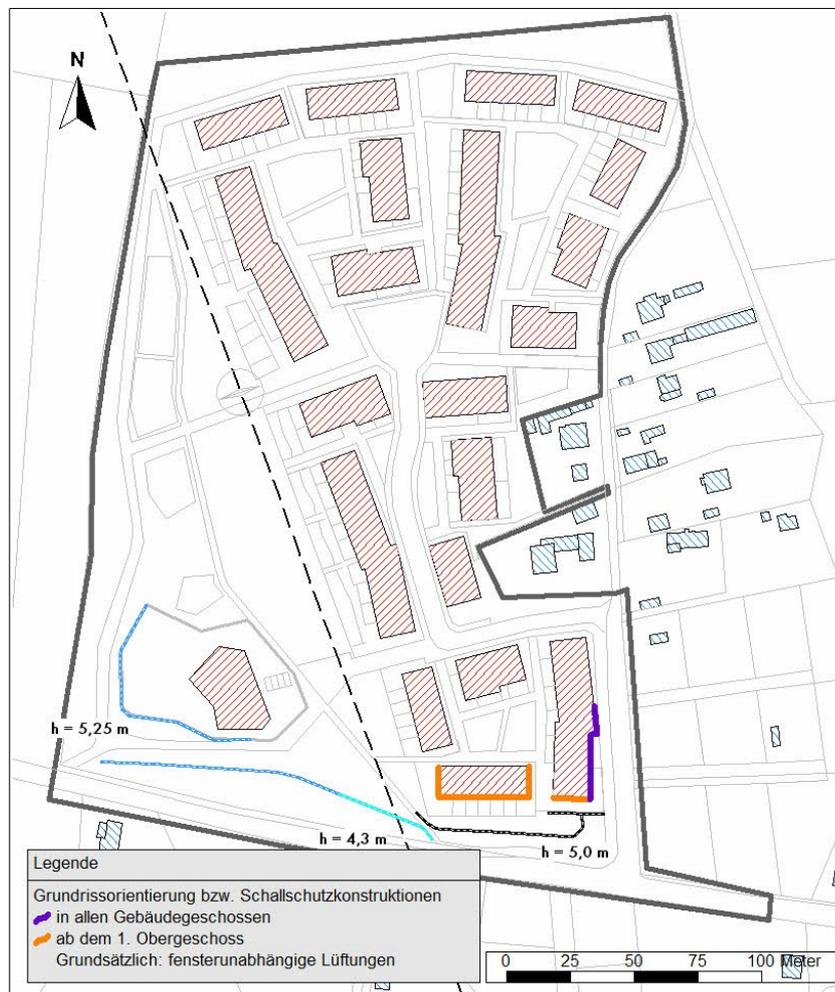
Fassaden mit Grundrissorientierung bzw. Schallschutzkonstruktionen Planfall
